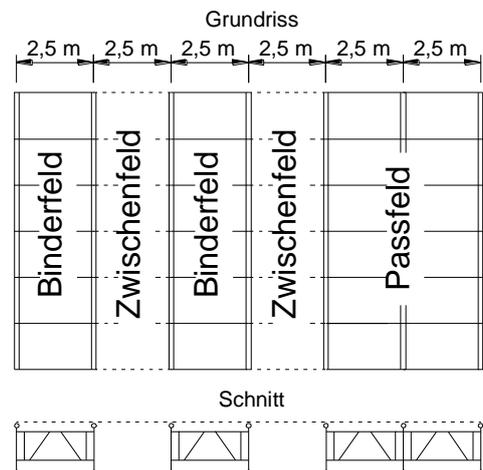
beispielhafter Grundriss für einen Dachaufbau mit einer ungeraden Anzahl von Feldern
